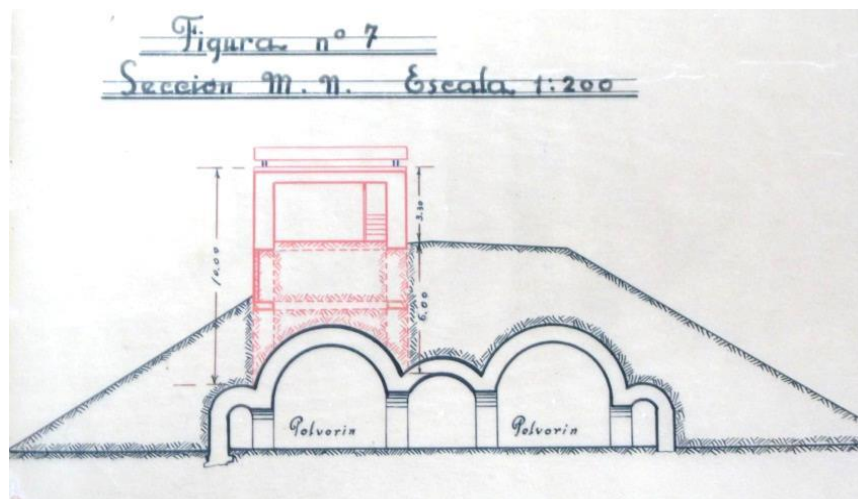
Sección transversal anteproyecto Torre y Polvorín. Planos cedidos por el Archivo Militar
